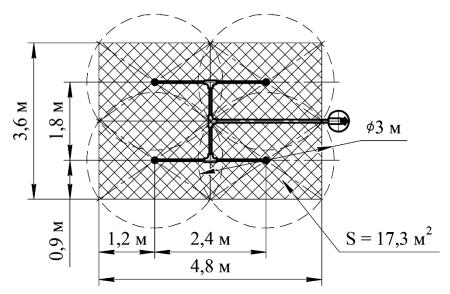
Вариант трубной разводки по вписанным прямоугольникам на 4 насадка-распылителя
